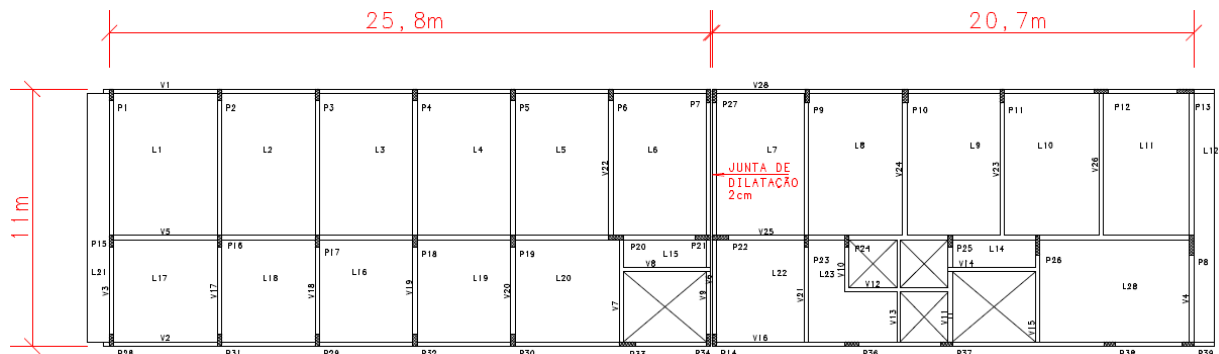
Lançamento preliminar do pavimento tipo com a presença da junta de dilatação. (Fonte: Autor, 2023)
